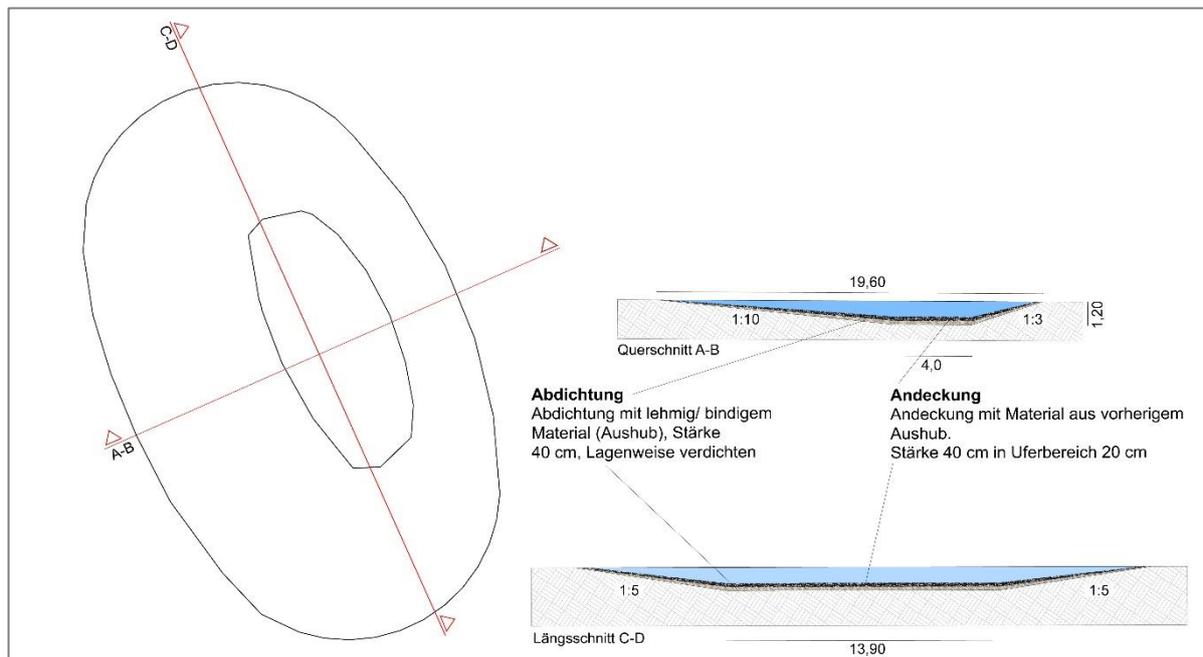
Detailplan Abdichtung und Andeckung Tümpel
